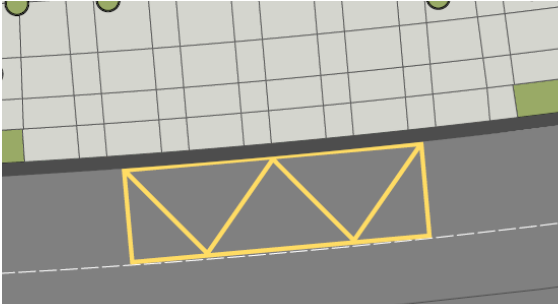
Parada de autobús pintada y con bahía propuesta para las Lilas Etapa 01. Fuente: URBE, octubre 2025
